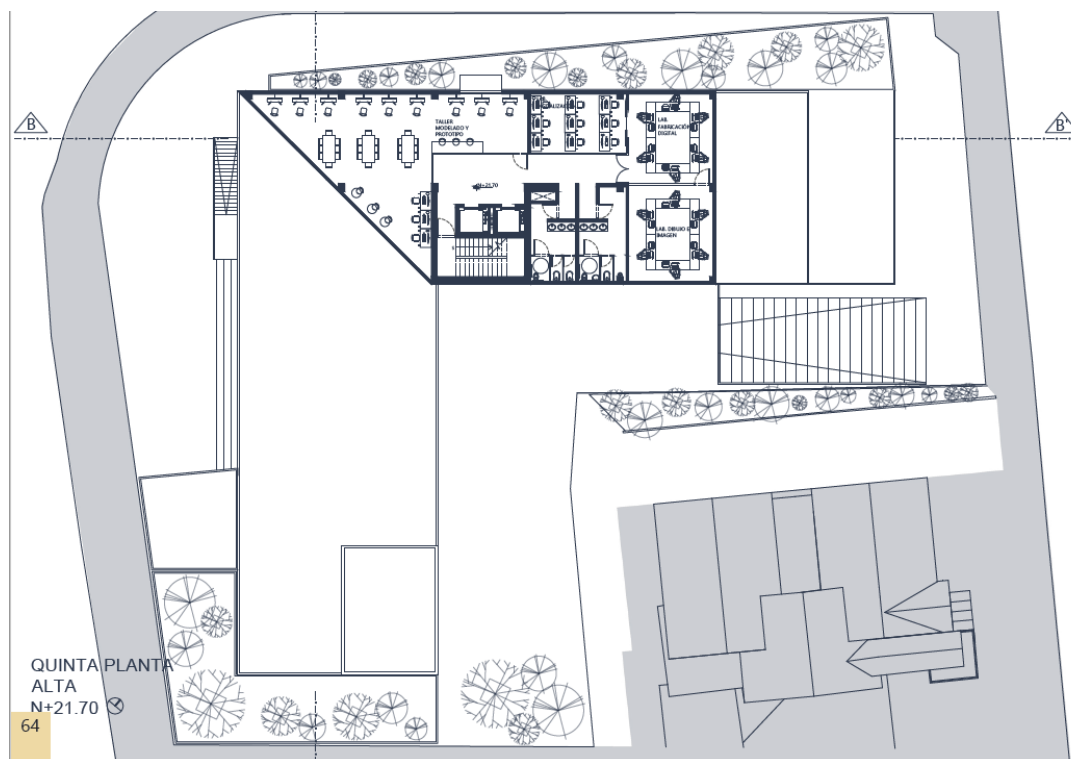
Quinta Planta Alta N+27.70. Autoría propia
